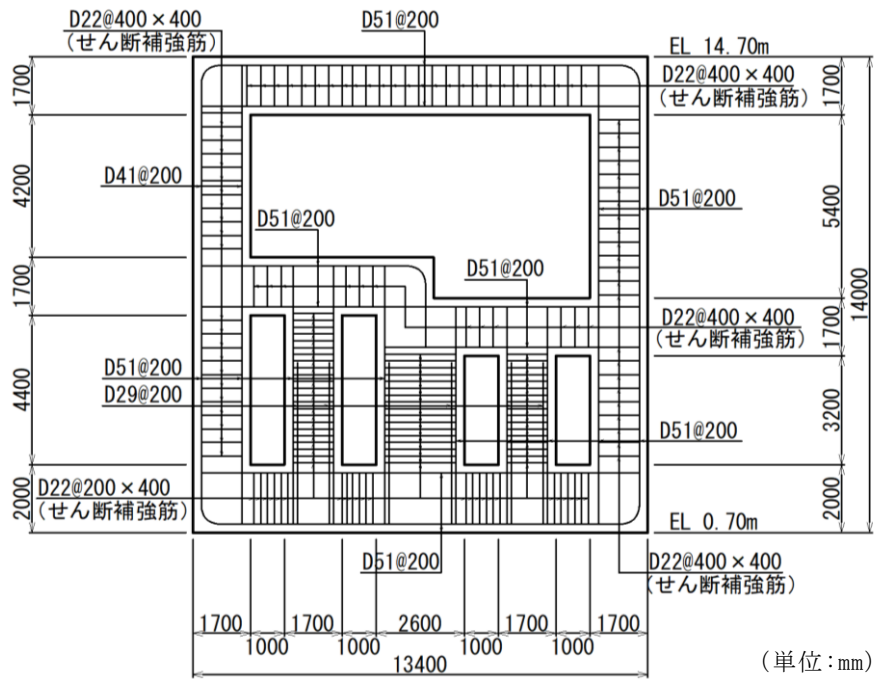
第 1 ベントフィルタ格納槽概略配筋図 (B-B 断面)
